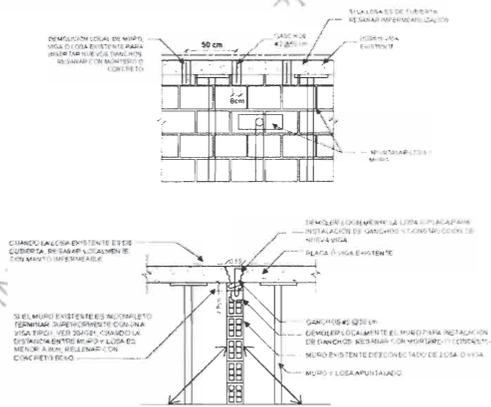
Conexión de muro nuevo a losa existente con nervios. Muro perpendicular a los nervios.
